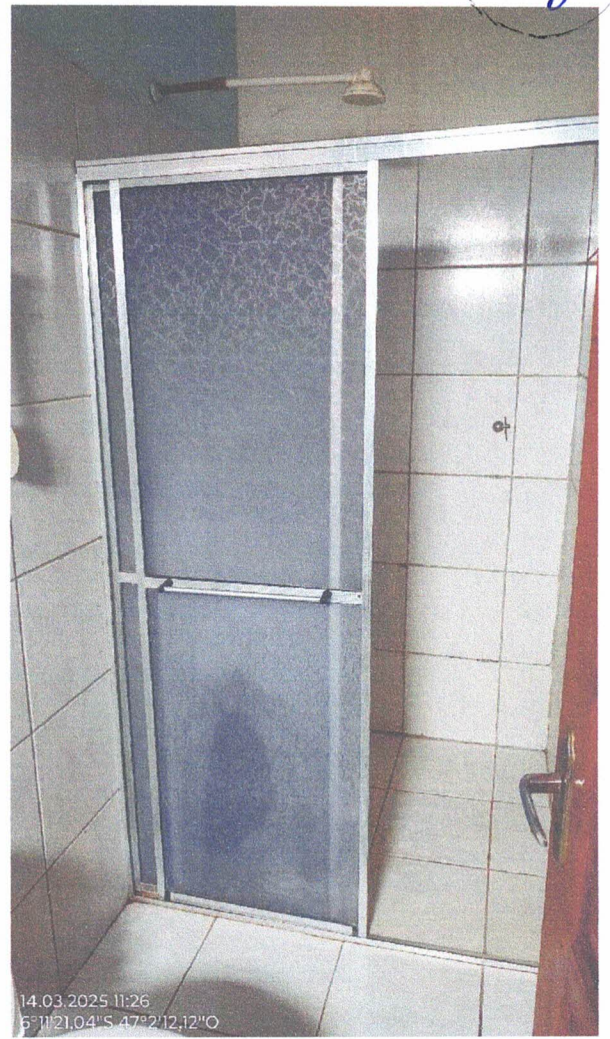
Banheiro 02 - Fonte: elaboração própria
